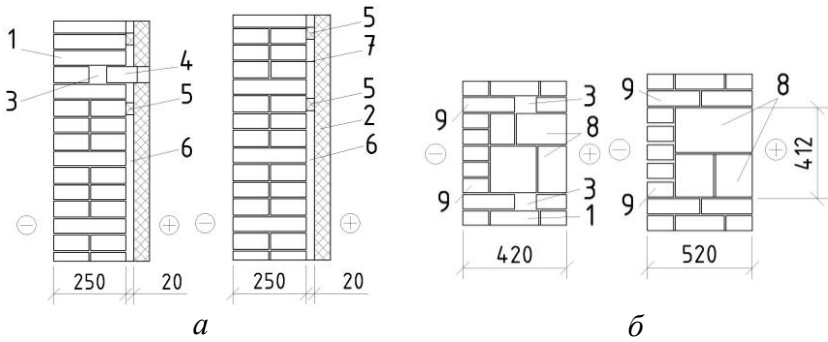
Типи стін полегшеної кладки: *а* – тип В; *б* – тип Г;
